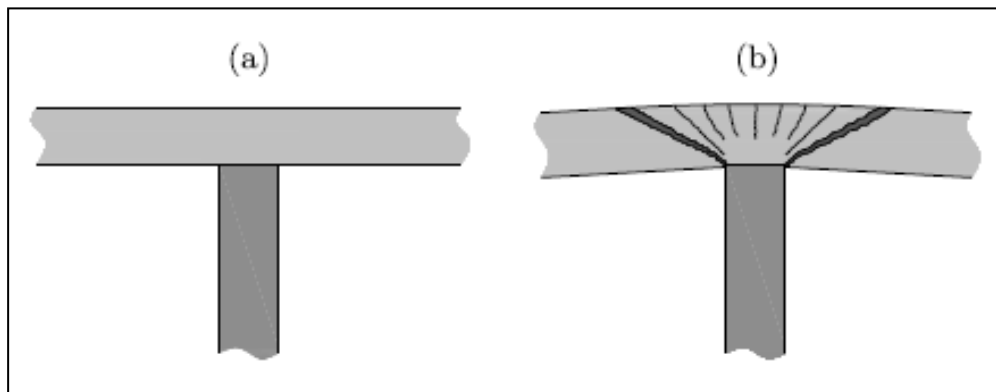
Plancher dalle : (a)avant fissurations, (b) après fissuration [84]
